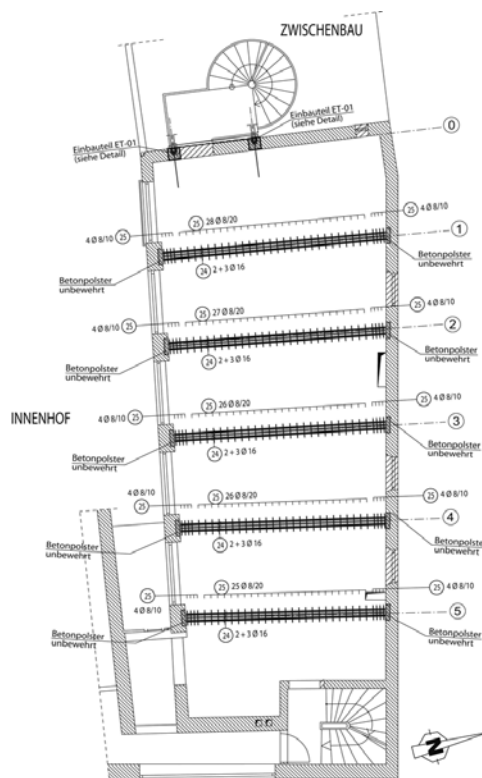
Grundriss und Bewehrung der Unterzüge Decke über 2.0G
